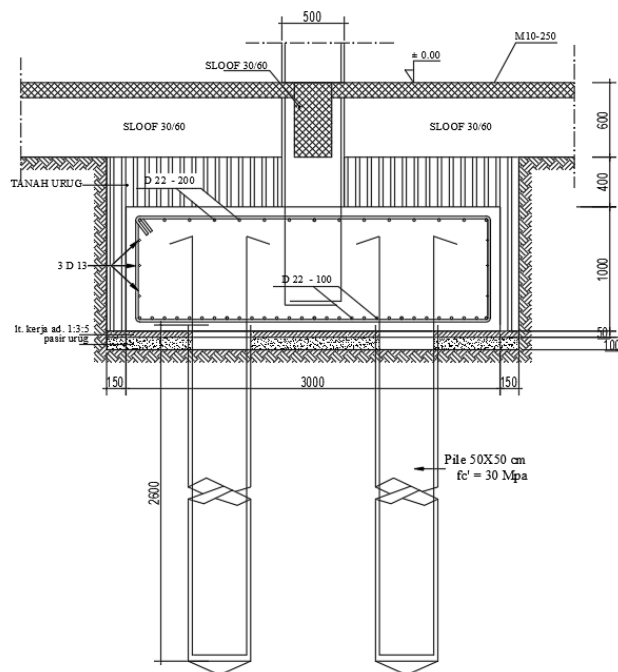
Detail Balok Sloof Arah Memanjang
